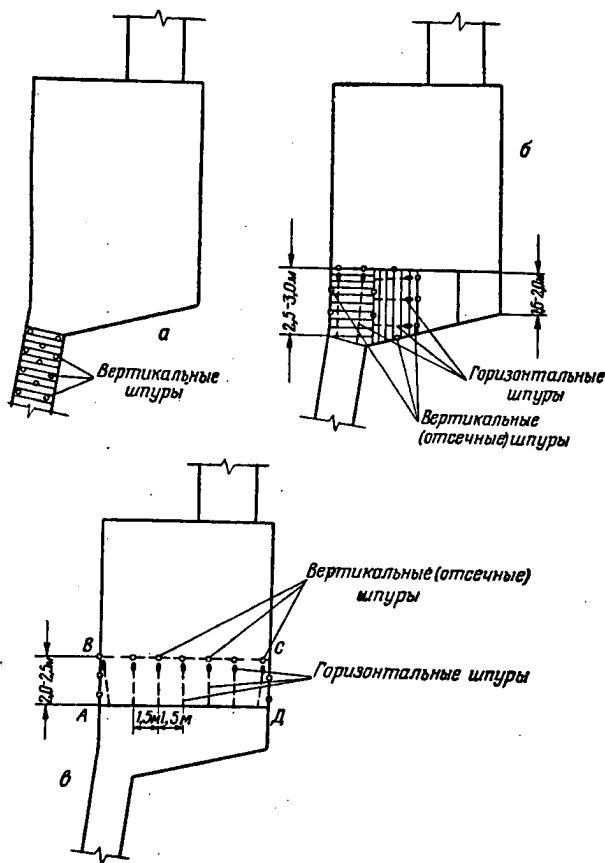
Схема разработки котлованов методом вертикального забоя.
